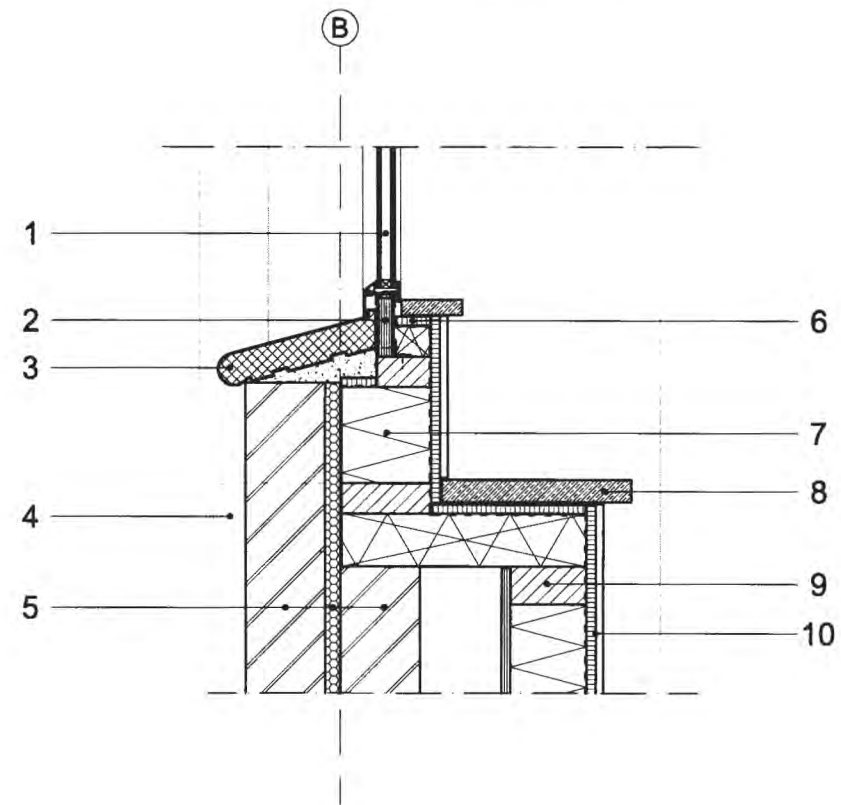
ONDERZIJDE GEVELOPENING BEGANE GROND EN 1<sup>E</sup> VERDIEPING
